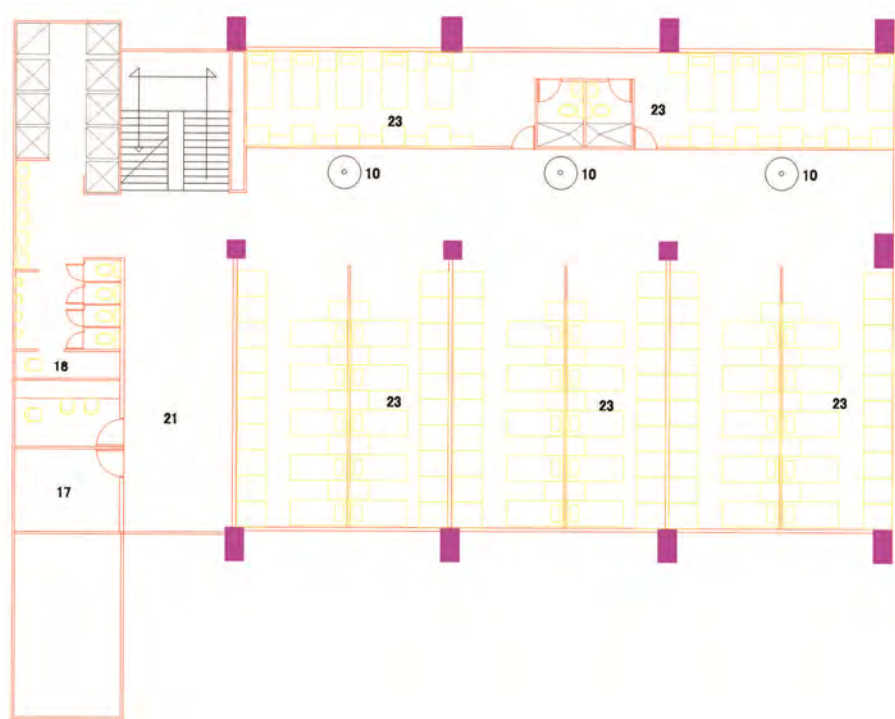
PLANTA SEGUNDO PISO ARQUITECTONICA, CENTRAL DE BOMBEROS IZTAPALAPA.
